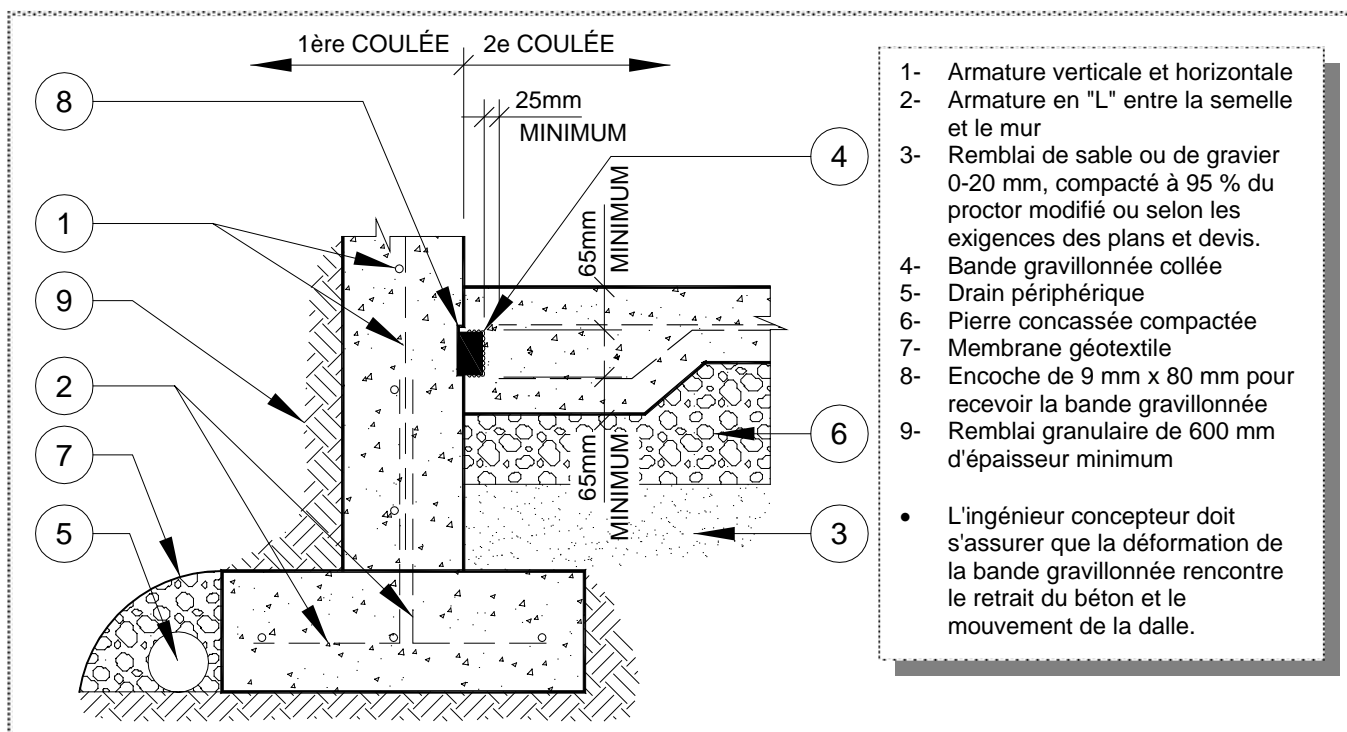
Étanchéité entre le mur de fondation et la descente (Joint de construction)
